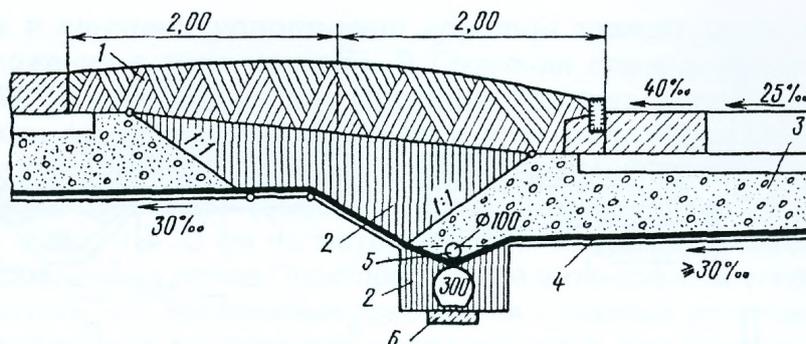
Расположение дренажных устройств для осушения морозозащитного слоя под разделительной полосой: 1 – растительный грунт; 2 – грунт земляного полотна; 3 – морозозащитный слой; 4 – полиэтиленовая пленка; 5 – дренажная трубка; 6 – бетонное основание
